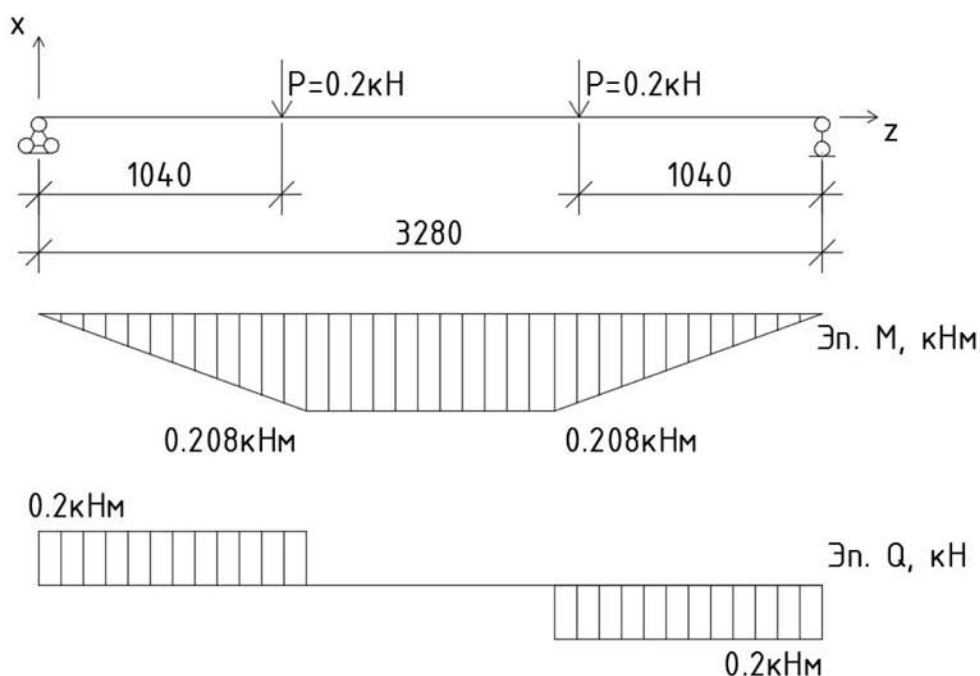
Расчетная схема, эпюры момента и поперечной силы Б1.
